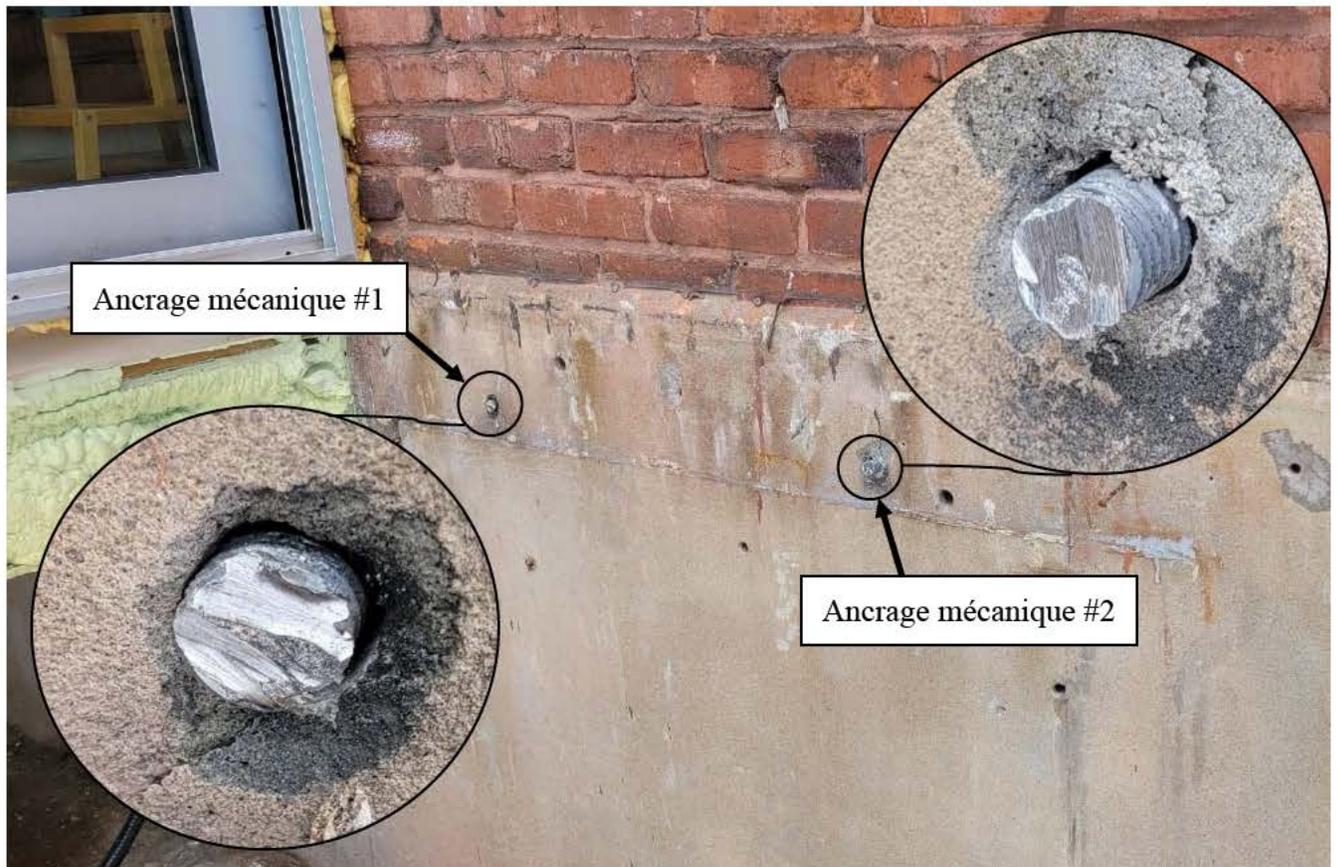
État des ancrages mécaniques de la fondation à la suite à la 2^e coupe
